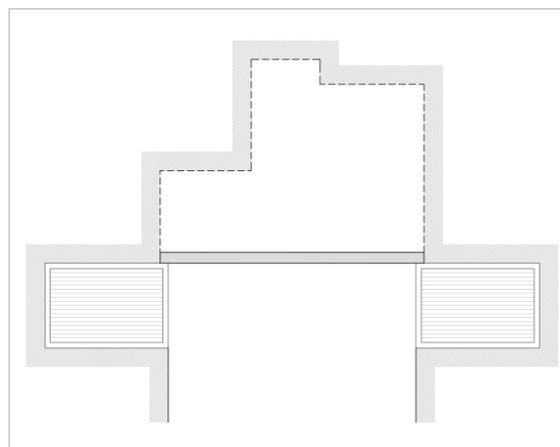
Esquema TIPO 2A con construcciones semiexcavadas laterales
